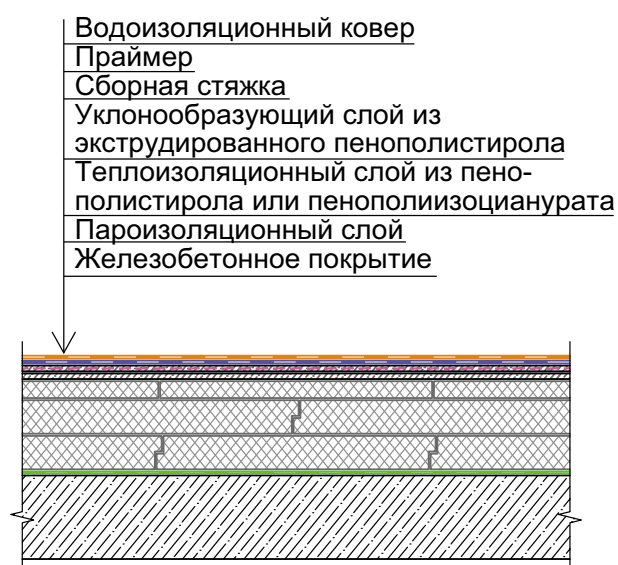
Кровля с теплоизоляцией из экструдированного пенополистирола или пенополиизоцианурата по железобетонному покрытию
